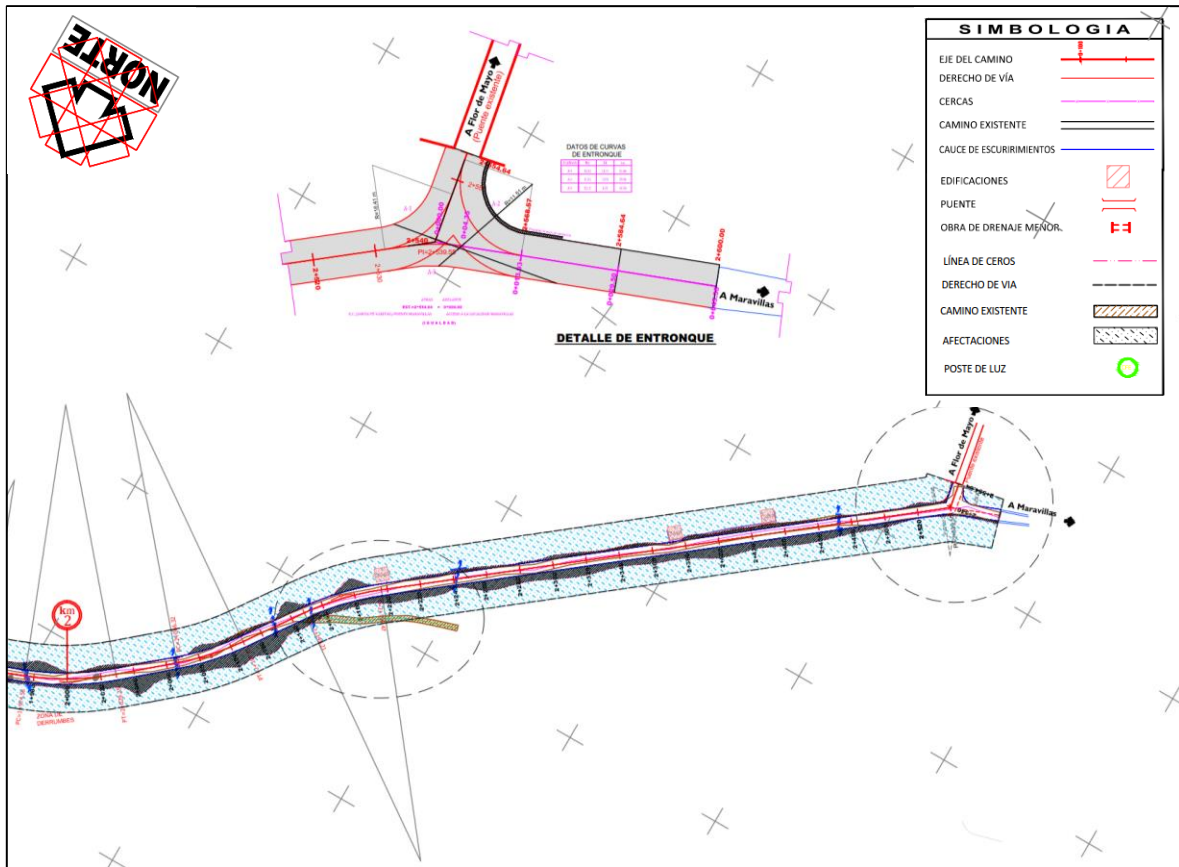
Planta general del proyecto y el entronque localizado en el Km 2+150.
